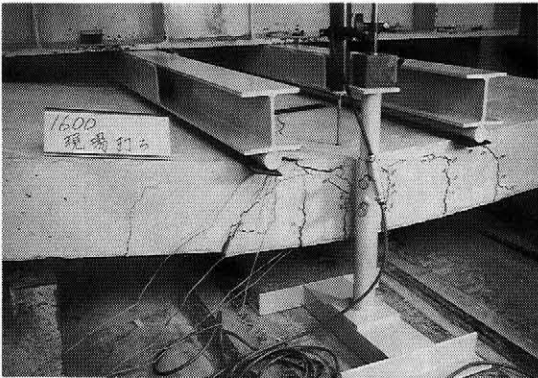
FL2600A(従来タイプ)ひび割れ状況
